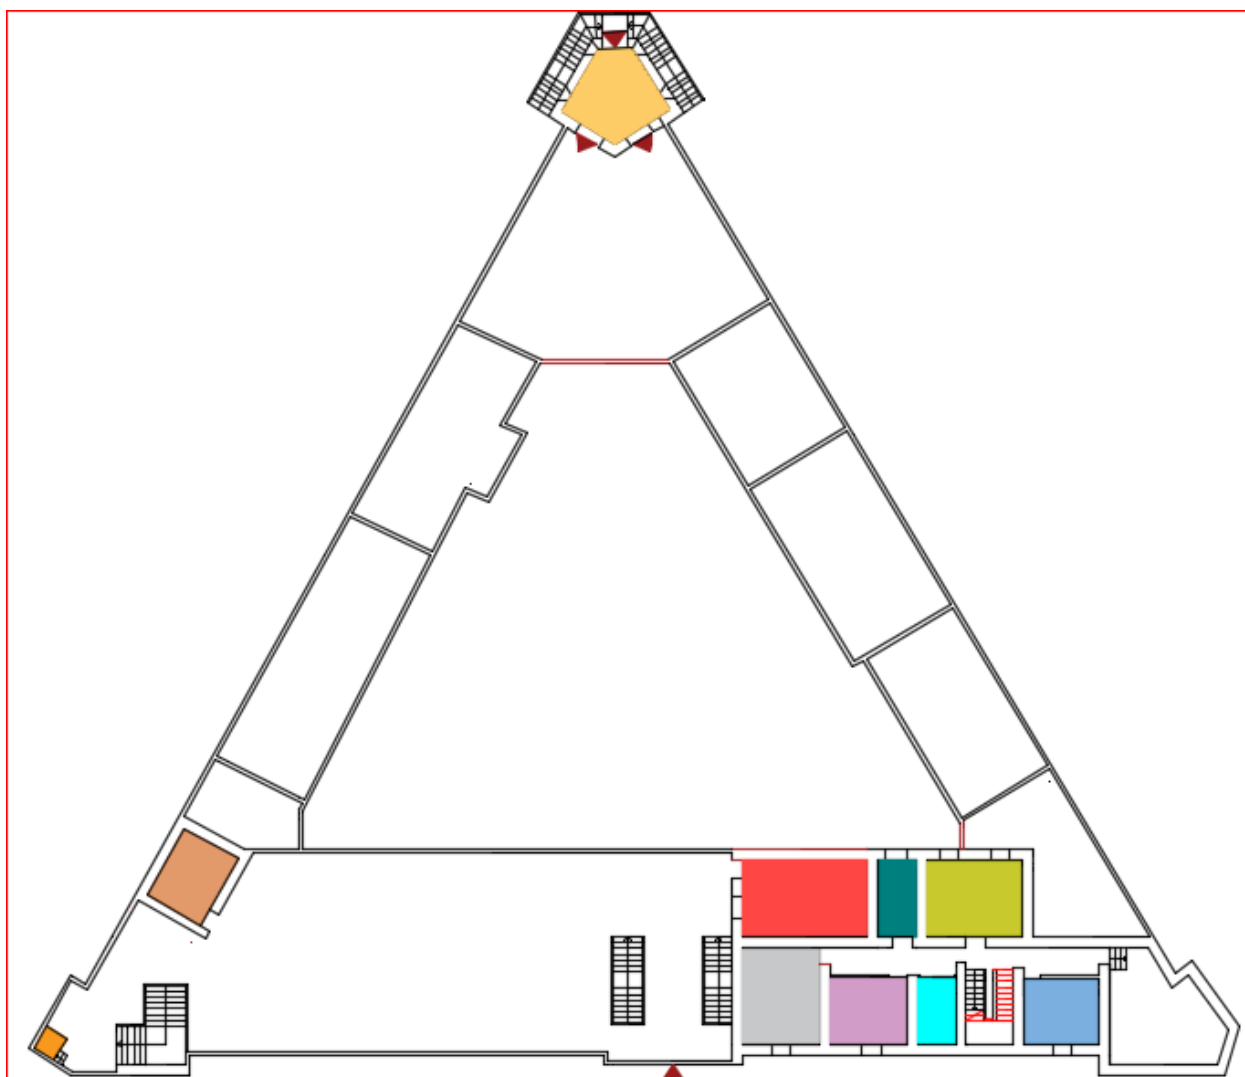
plans 1<sup>er</sup> niveau après les modifications- élaboré par l'auteur
